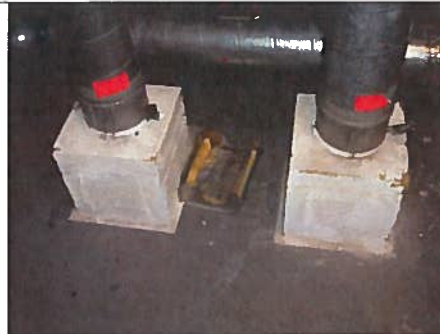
Brandwerende doorvoeringen met (automatische) afsluiters in de luchtkanalen
